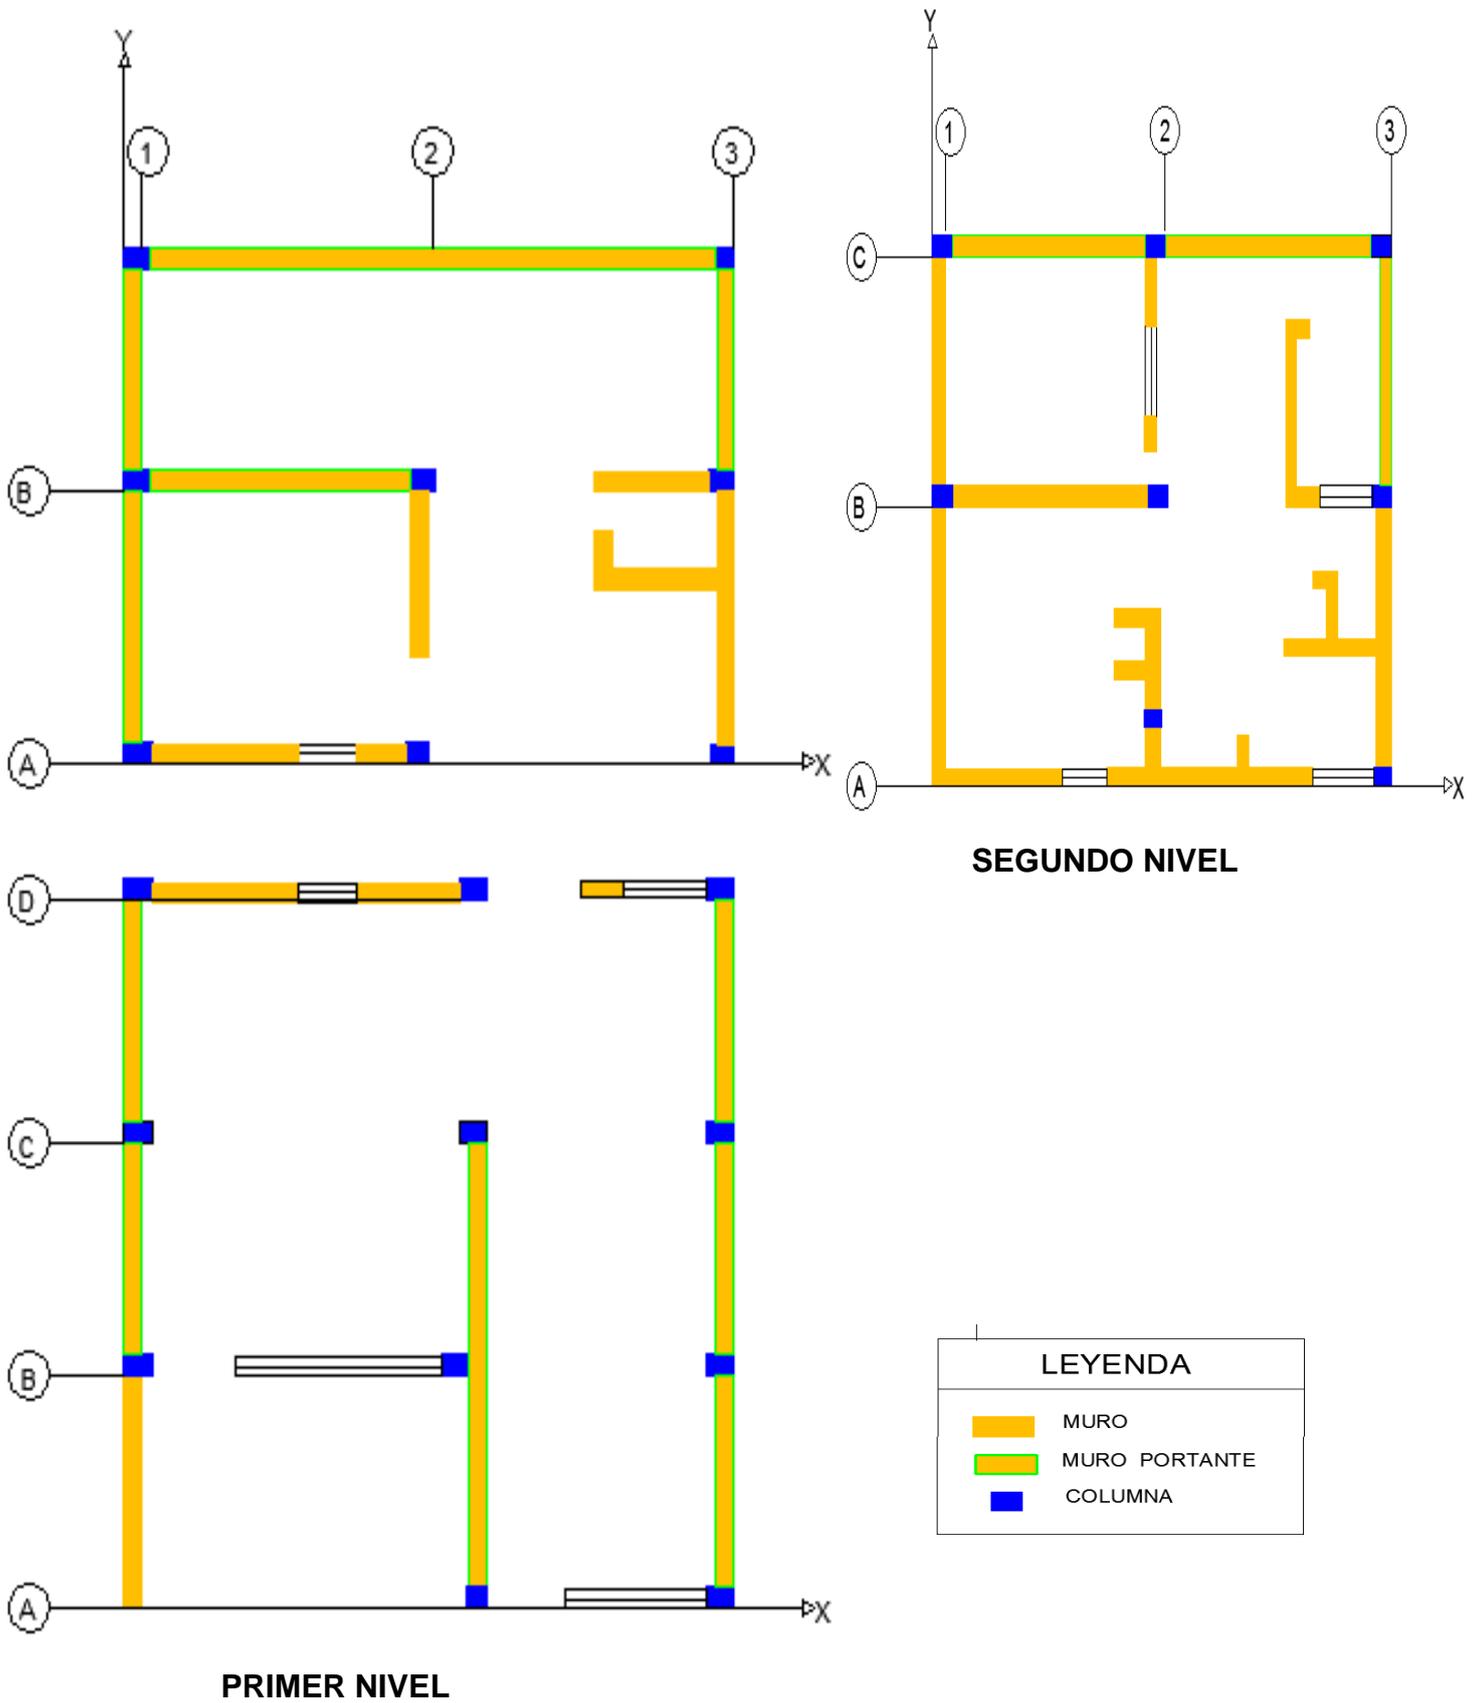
Croquis de distribución de los elementos estructurales de la vivienda V1.Regularidad
